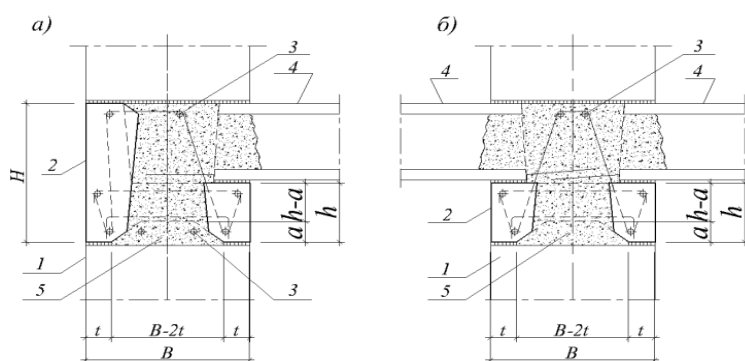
Сборно-монолитный пояс в узле соединения стены с перекрытием: а - наружный; б - внутренний; 1 - стена; 2 - сборный поясной блок; 3 - монтажная арматура; 4 - сборное перекрытие с арматурными выпусками; 5 - монолитный бетон [разработка автора].
